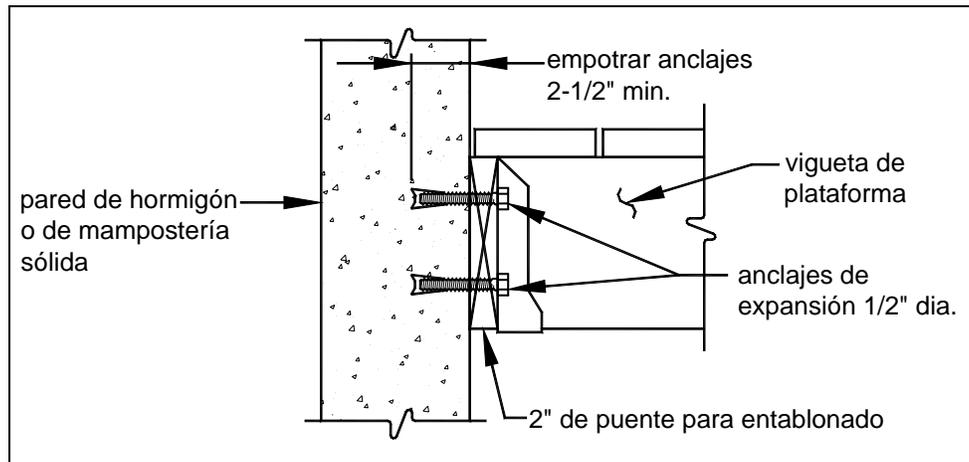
UNIÓN DEL PUENTE PARA ENTABLONADO CON LA PARED DE CIMENTACIÓN (HORMIGÓN O MAMPOSTERÍA SÓLIDA)
